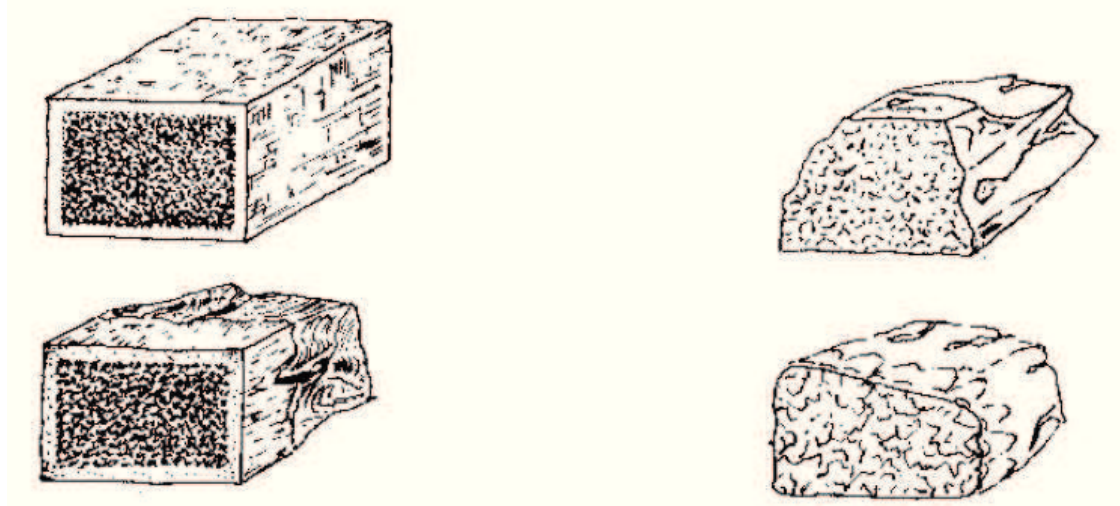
Exemplos de pedras para a alvenaria Aparelhada.
